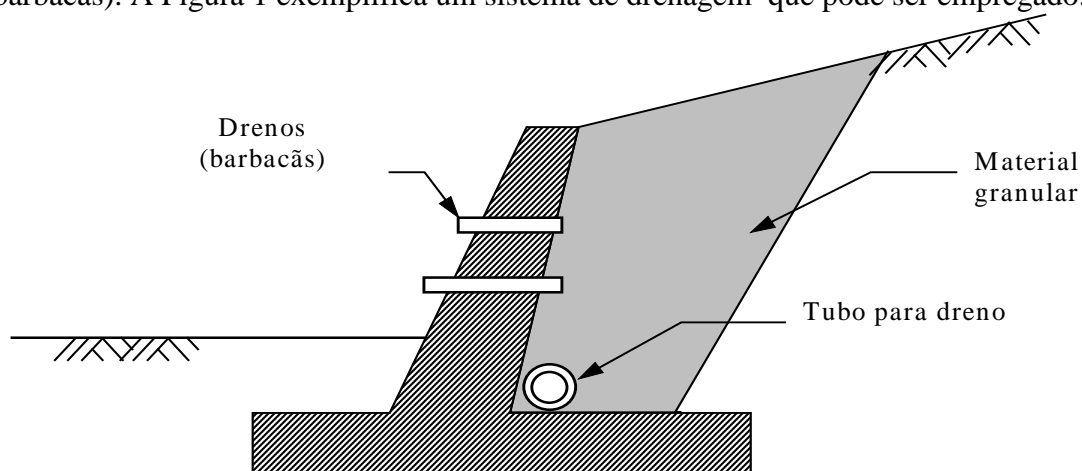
Exemplo de sistema de drenagem em muro de arrimo
